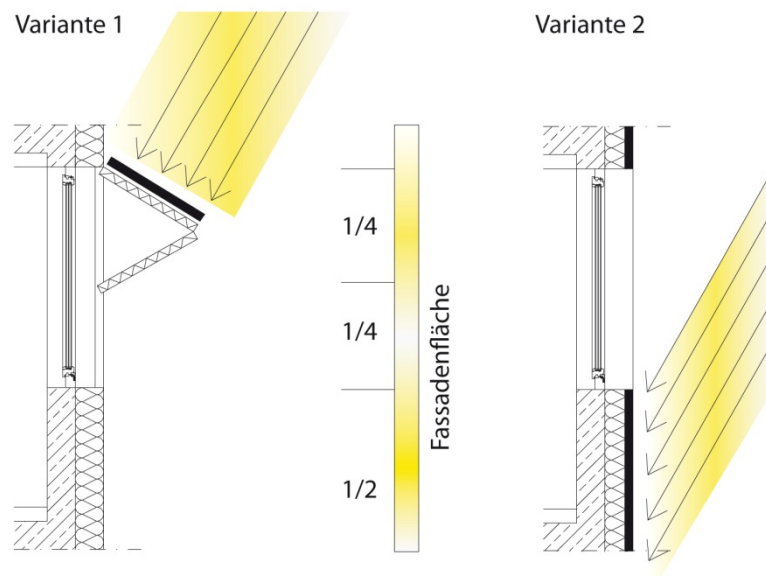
Funktionsskizze von fassaden- und dämm-ladenintegrierter PV¹⁹⁸
